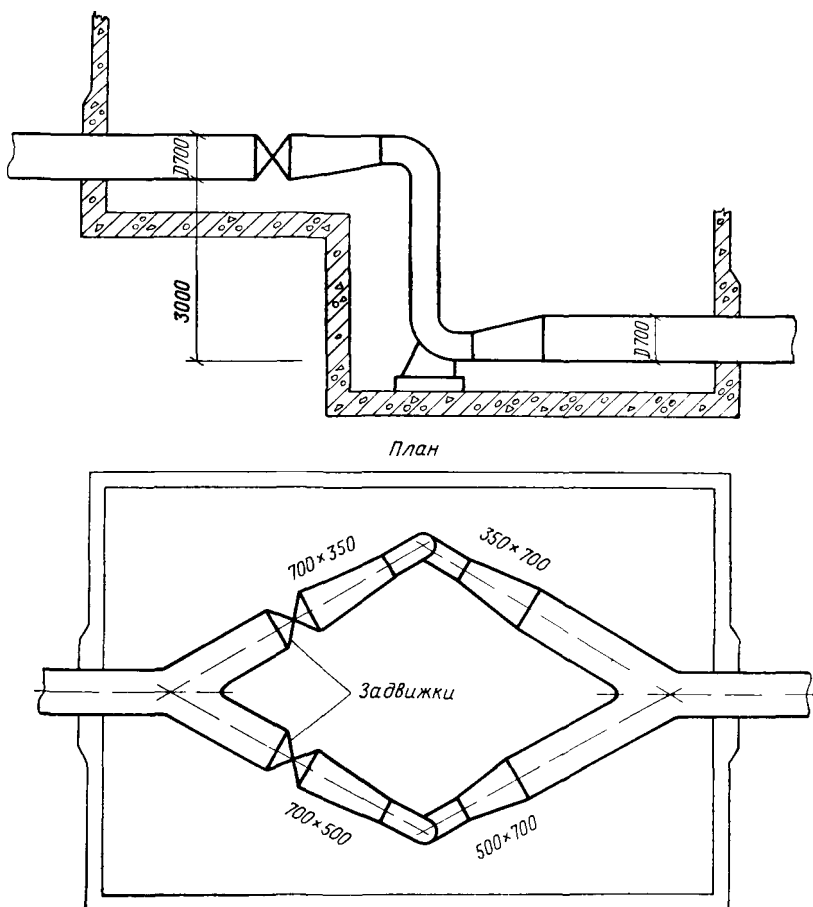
Схема перепадного устройства на сифонном водоводе действующего водопровода
